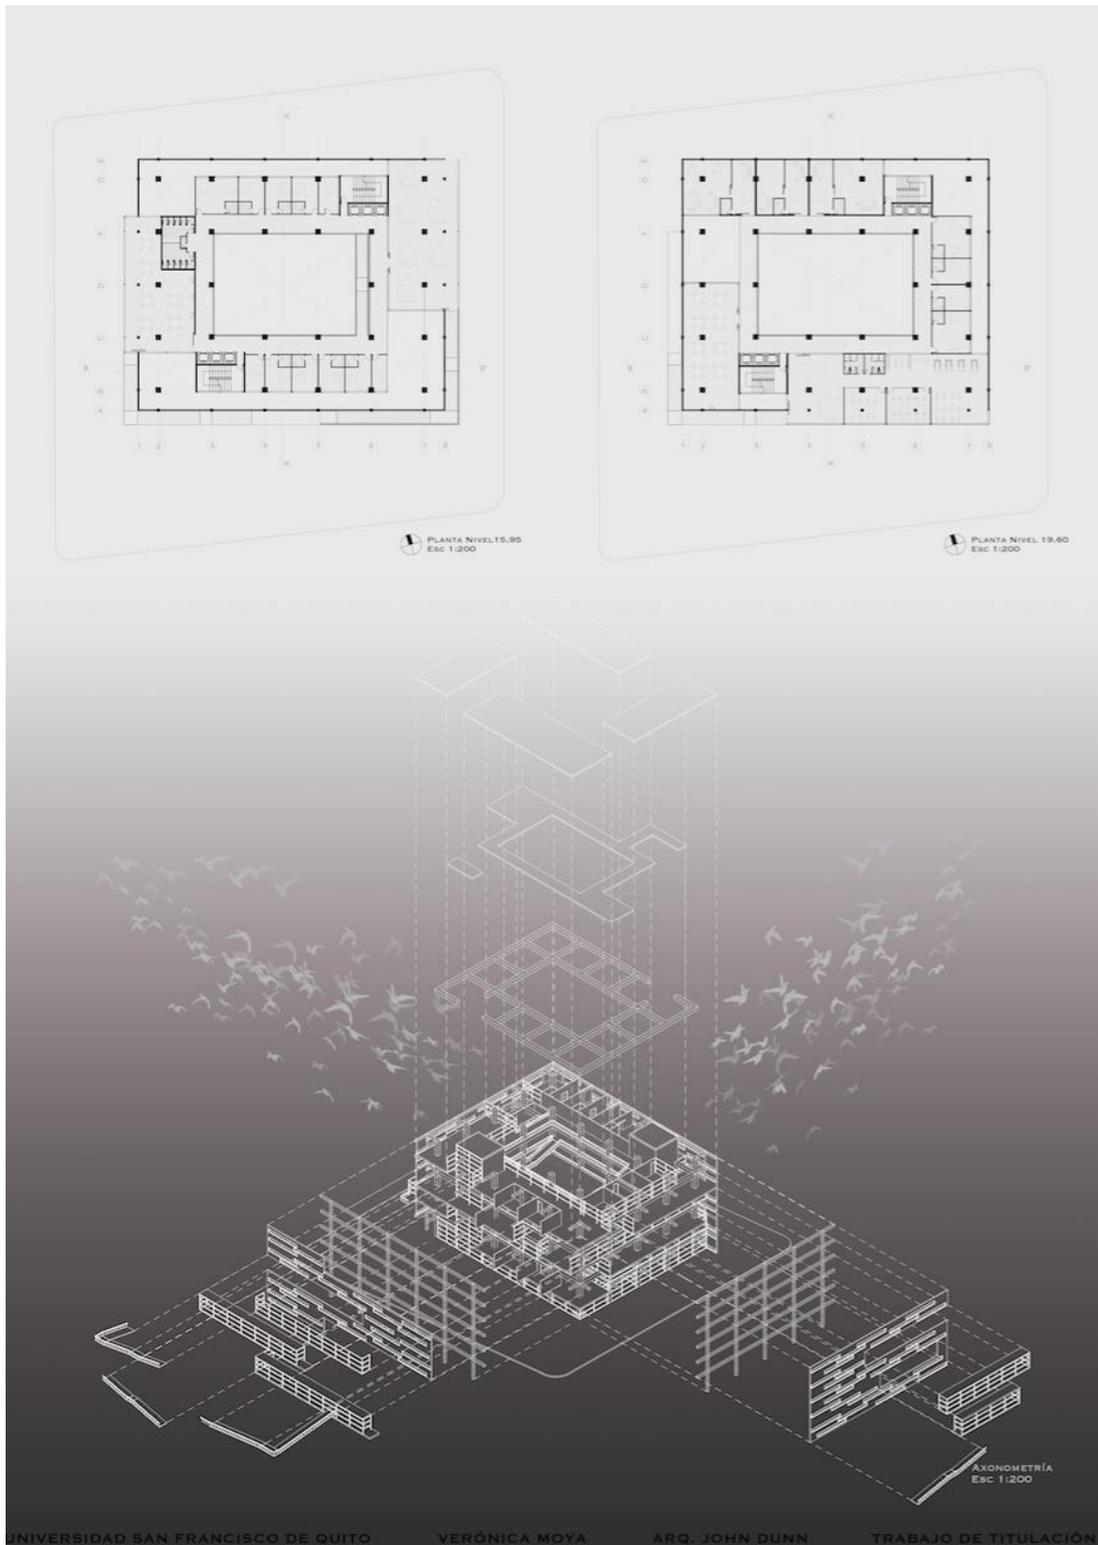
Lámina Axonometría y Plantas Arquitectónicas (Elaboración Propia)
